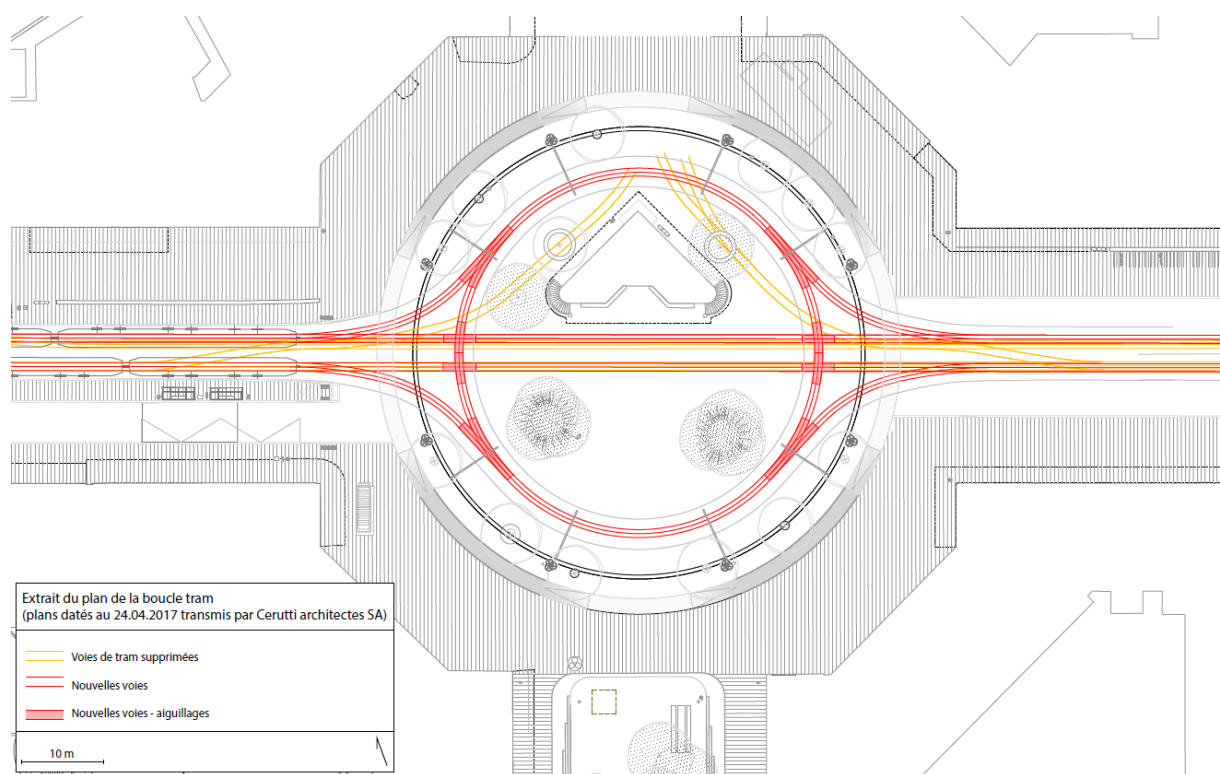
Extrait du plan de modification des voies de tram (avril 2017).
